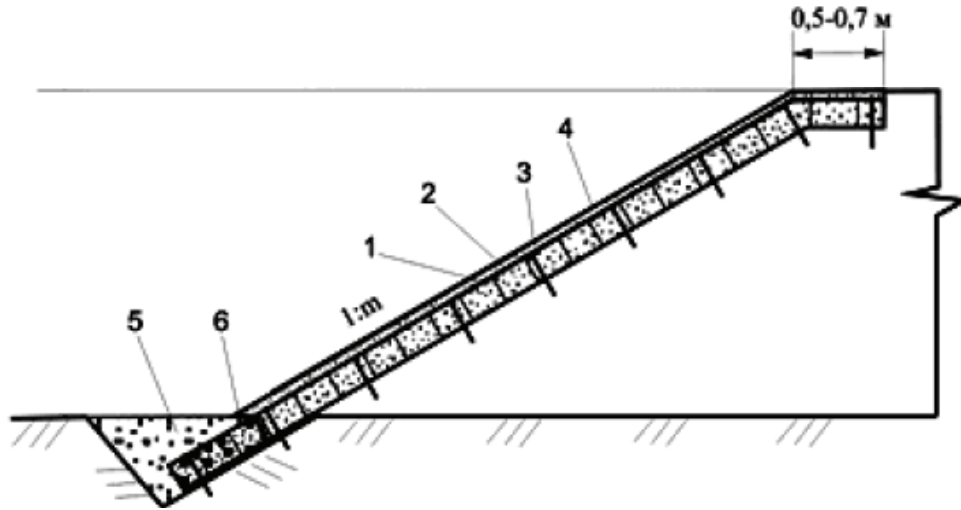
Конструкция укрепления откосов неподтопляемой насыпи с наличием в основании связанных переувлажненных грунтов
